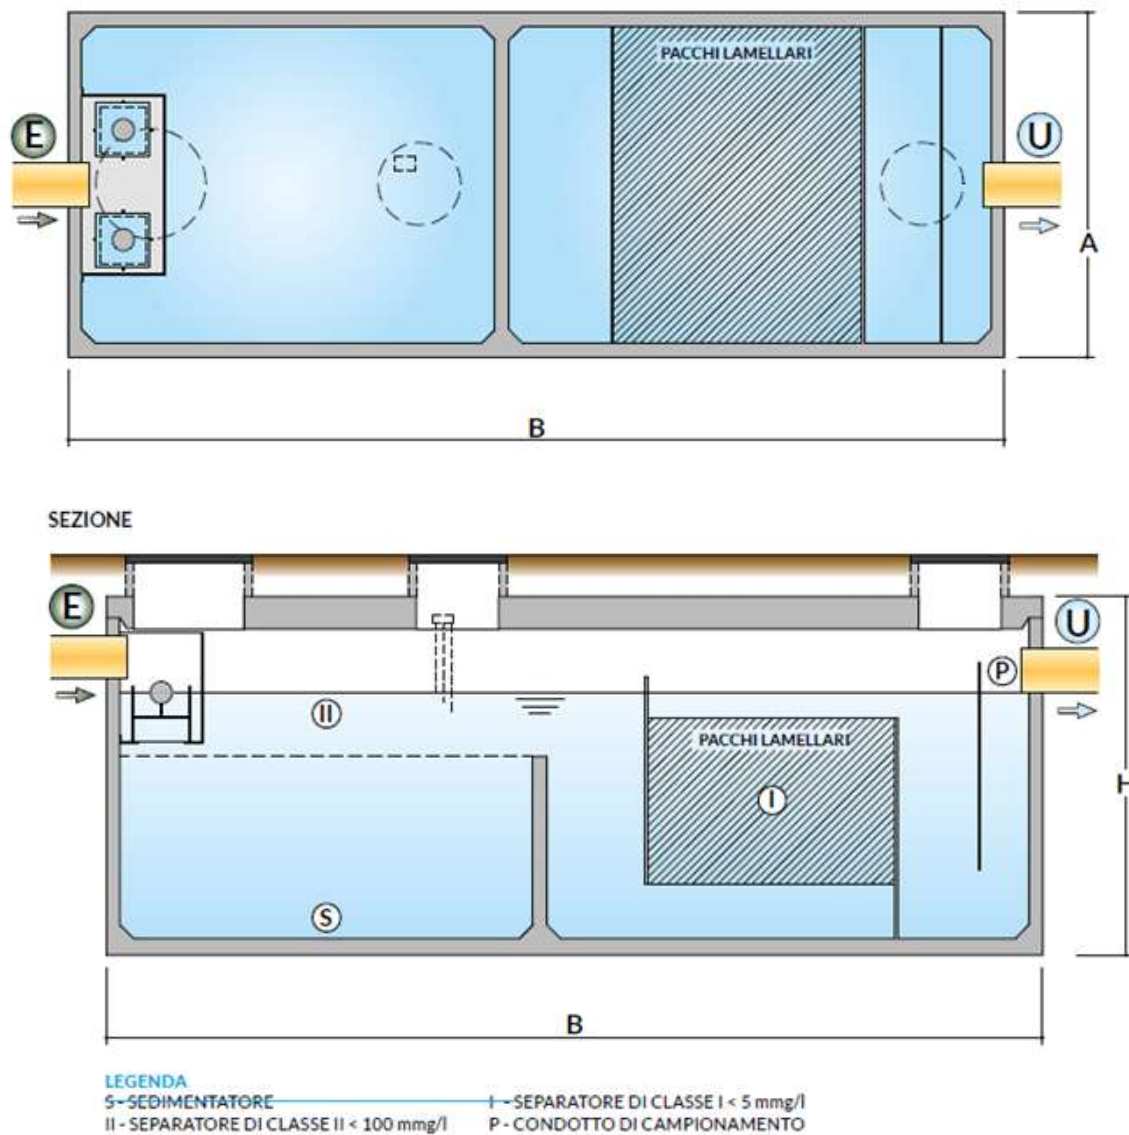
Pianta e sezione dell'impianto di trattamento acque di prima pioggia
